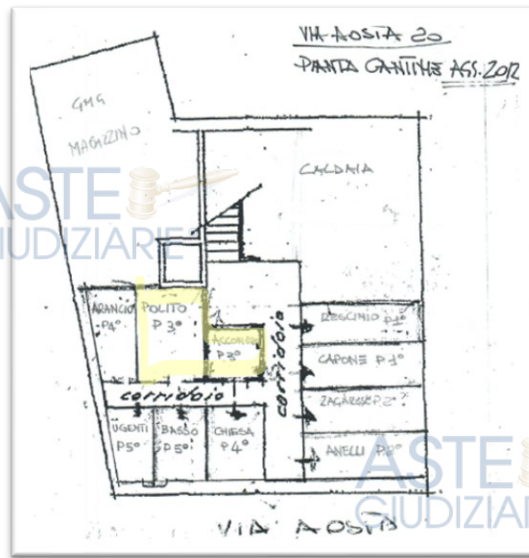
estratto planimetria piano cantine allegata al regolamento di condominio
